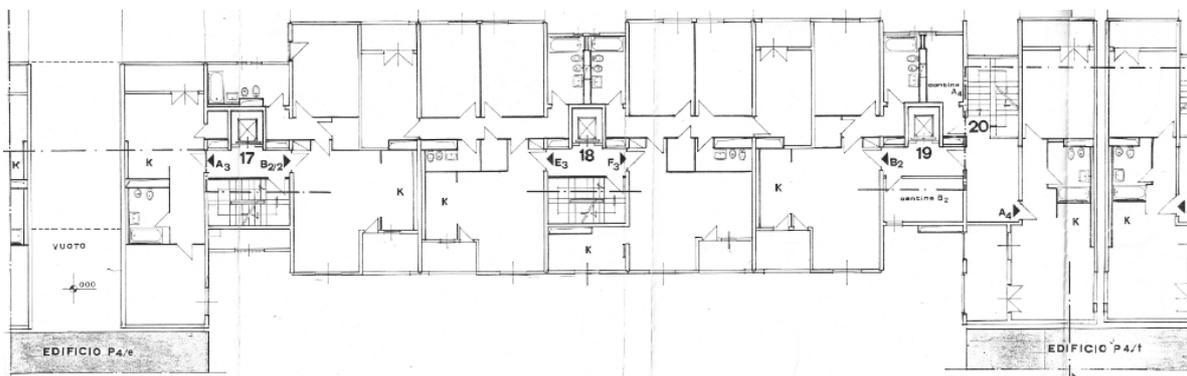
Pianta piano terra di una porzione del corpo P4a tra il corpo P4e e P4f
